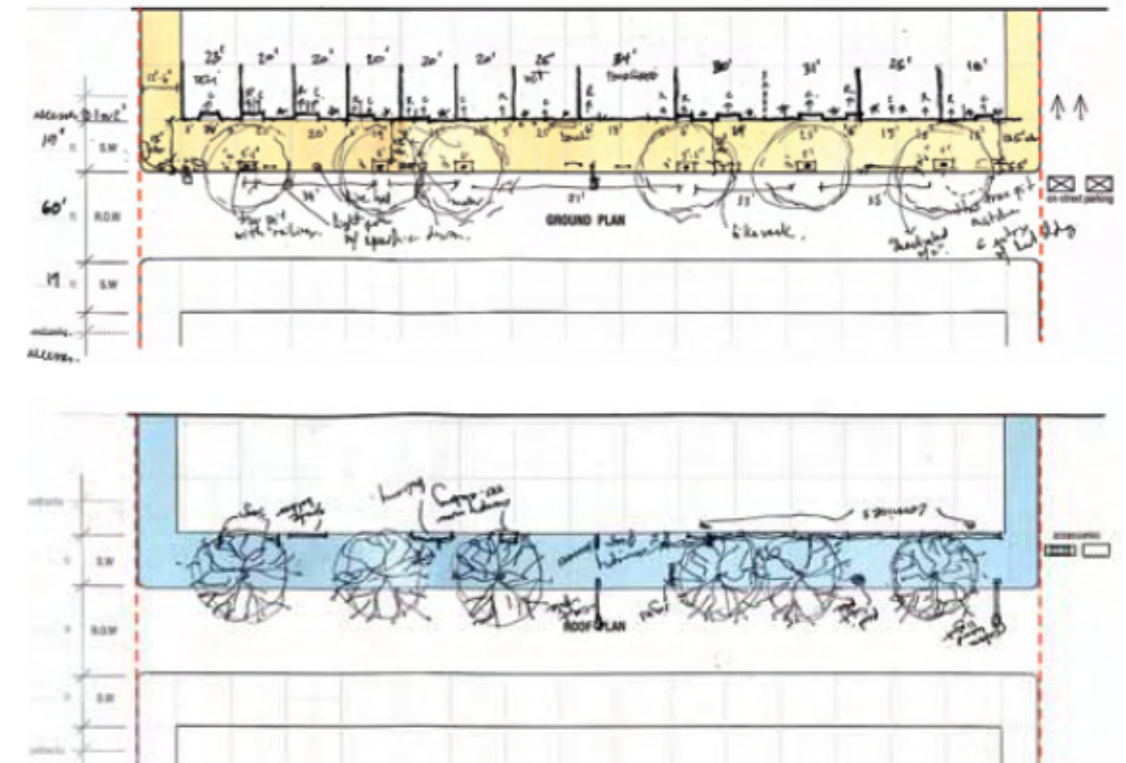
Divisão da calçada em planos: piso (*ground plane*), “cobertura” (*canopy*), fachadas (*building wall*) e plano da via (*roadside*). Fonte: CIDADE DE NOVA YORK, 2013.
